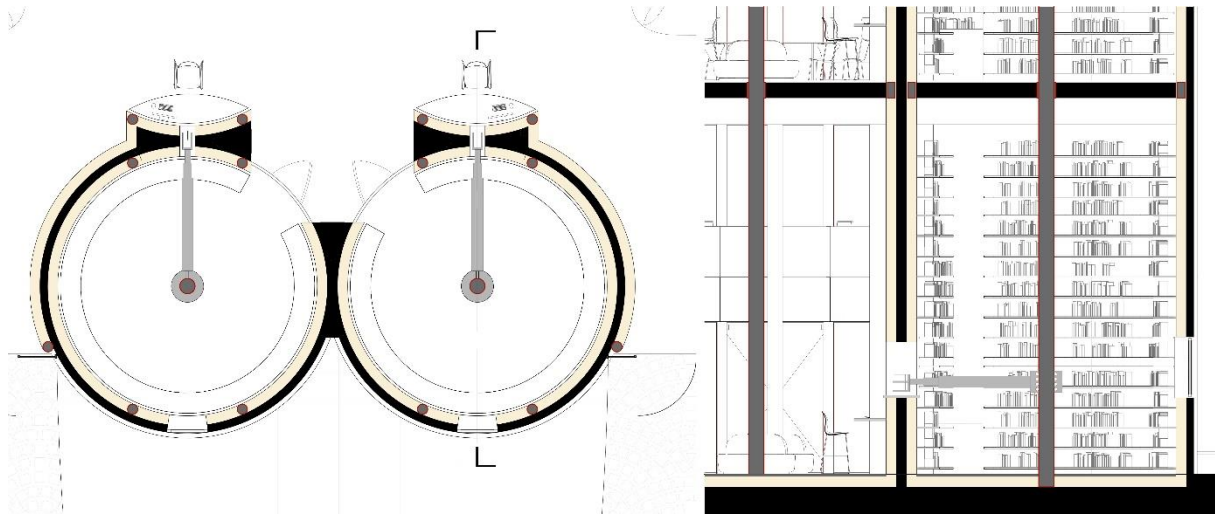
Grundriss und Schnitt einer Magazinzeile.
